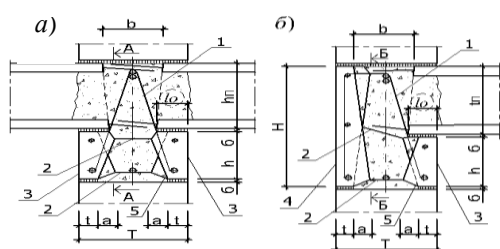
Конструкция СбМм поясов (Вм3) для тонких ($T=20-30$ см), внутренних (а) и наружных (б) стен с поперечной арматурой (1), арматурными перемычки (2) и шпонками (5) (рис. автора).
